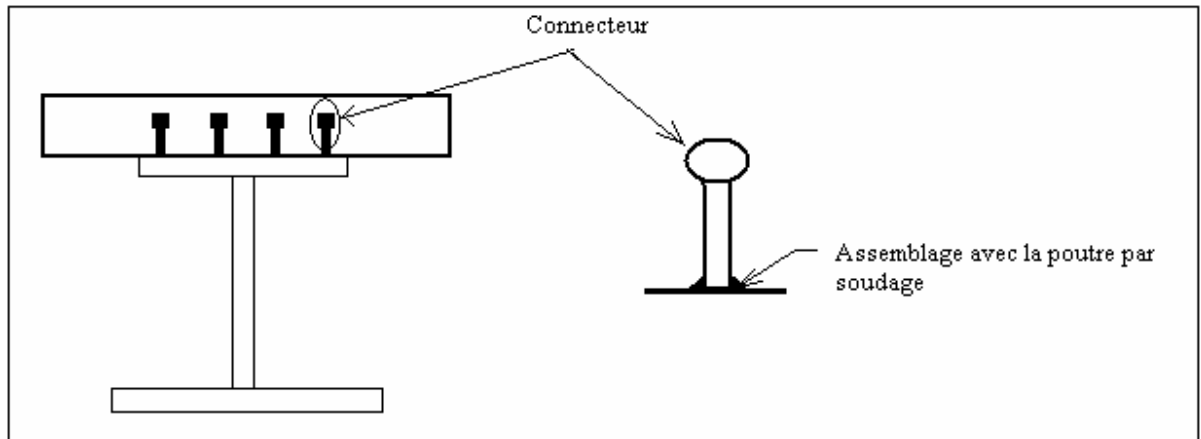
Assemblage avec connecteur poutre – dalle
